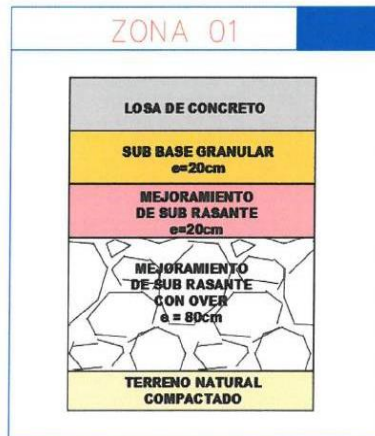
Sección recomendada de pavimento ZONA 01. Fuente: Elaboración Propia.
